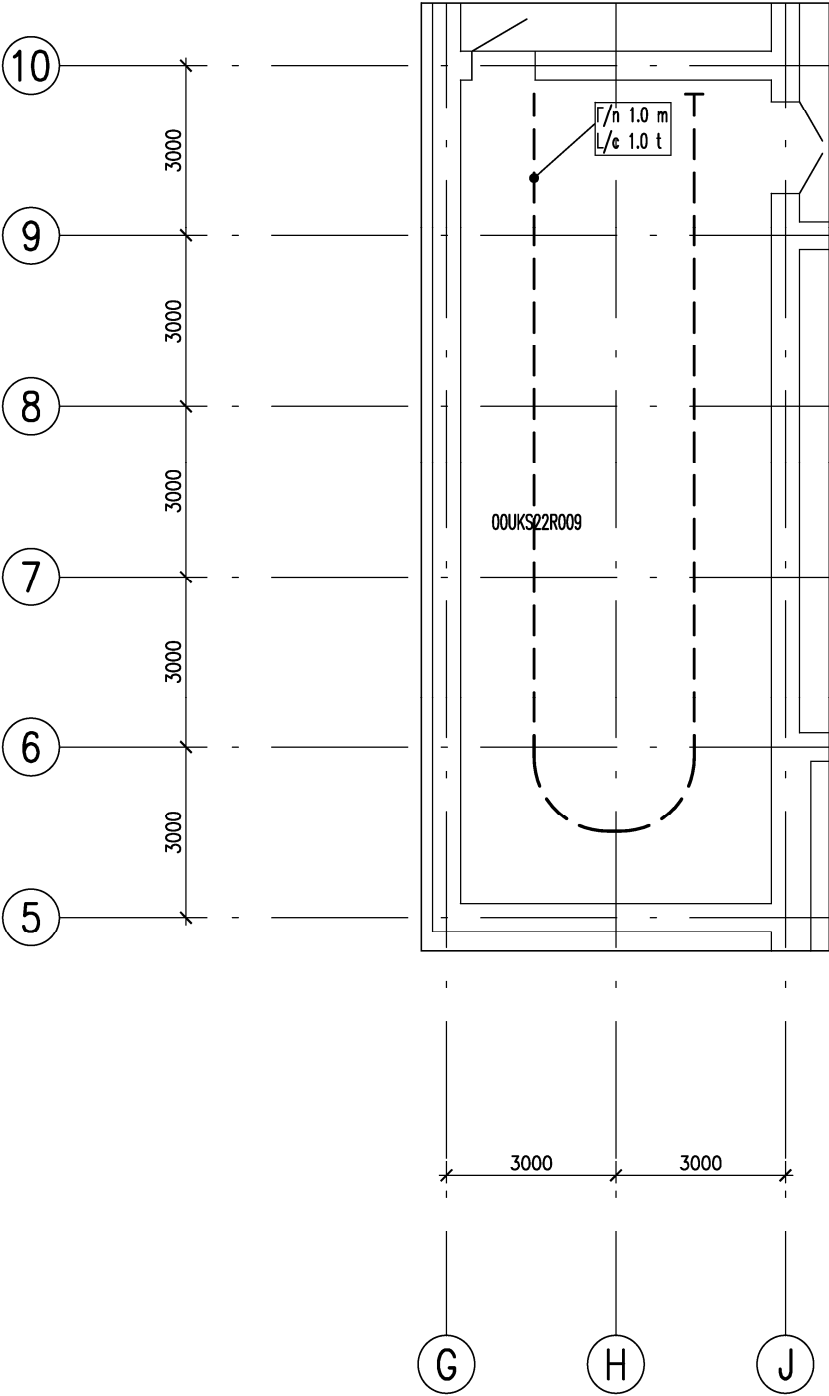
Габаритные размеры помещения фильтров HEPA 00UKS22R009 (с площадками обслуживания на отм. +3,700, +6,000 и перекрытием на отм. +12,600)
